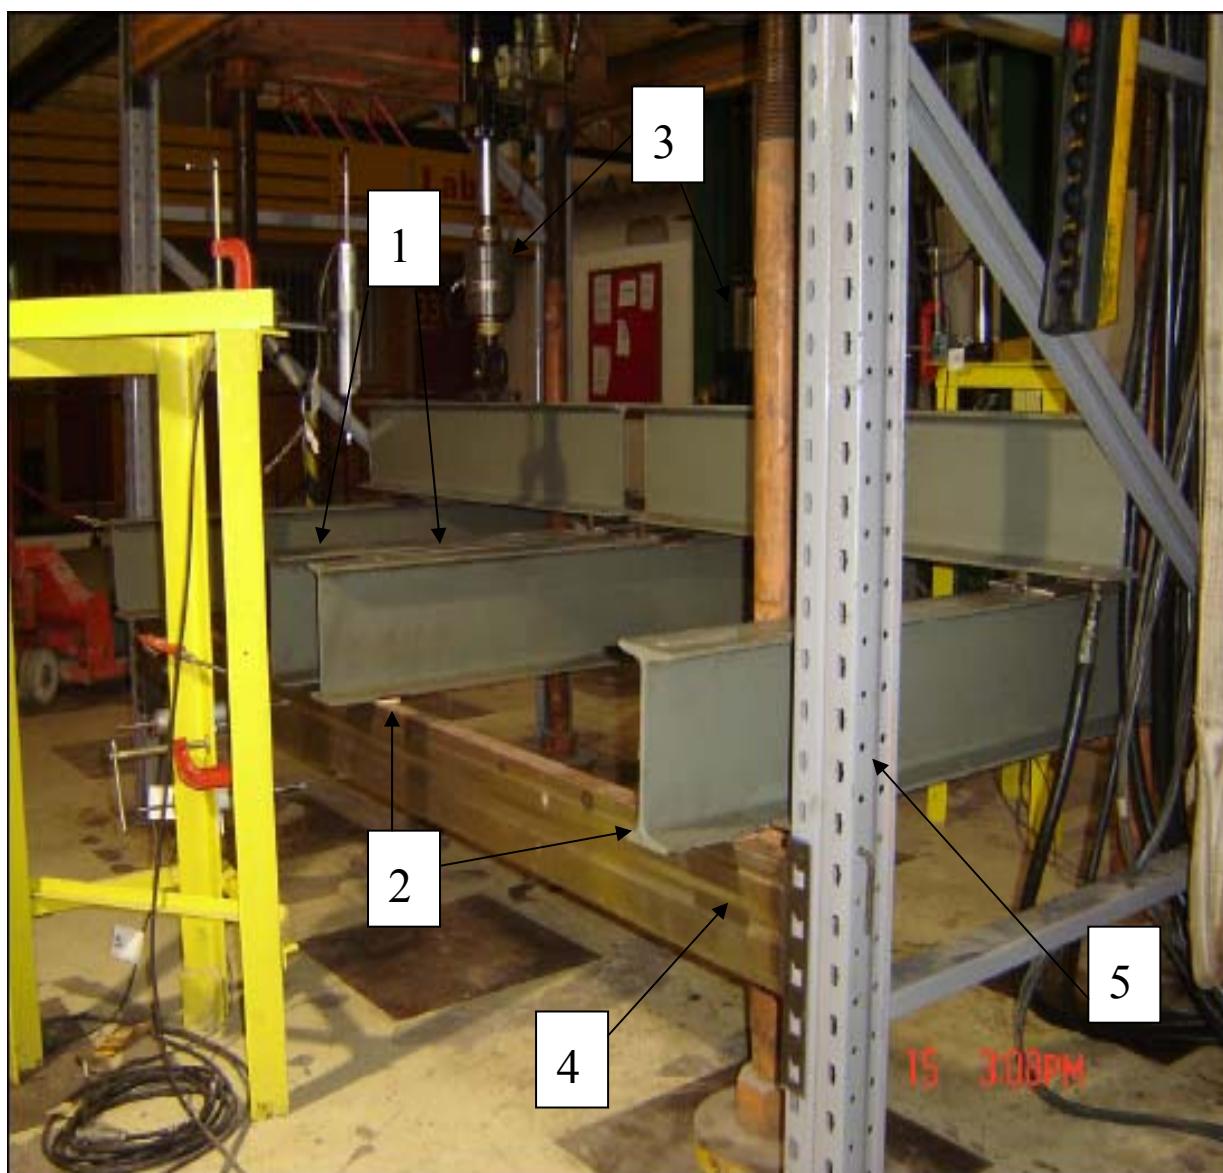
Montagem do ensaio da longarina de seção fechada: 1- Vigas de montagem; 2 – Pontos de aplicação da carga na longarina; 3 - Atuadores hidráulicos de 5 tf; 4 - Uma das longarinas a serem ensaiadas; 5 - Montante
